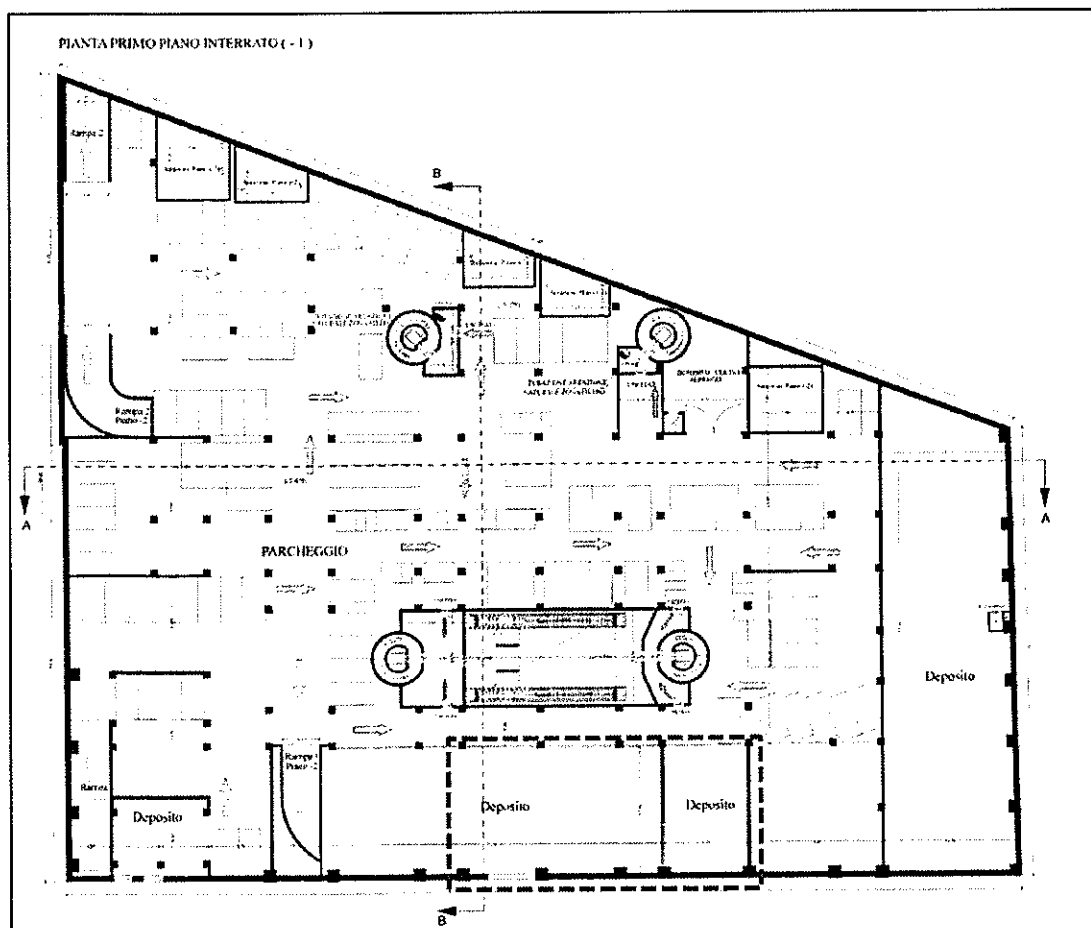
Progetto del piano primo interrato estratto dalla tavola allegata al PdC n. 59/2013.
